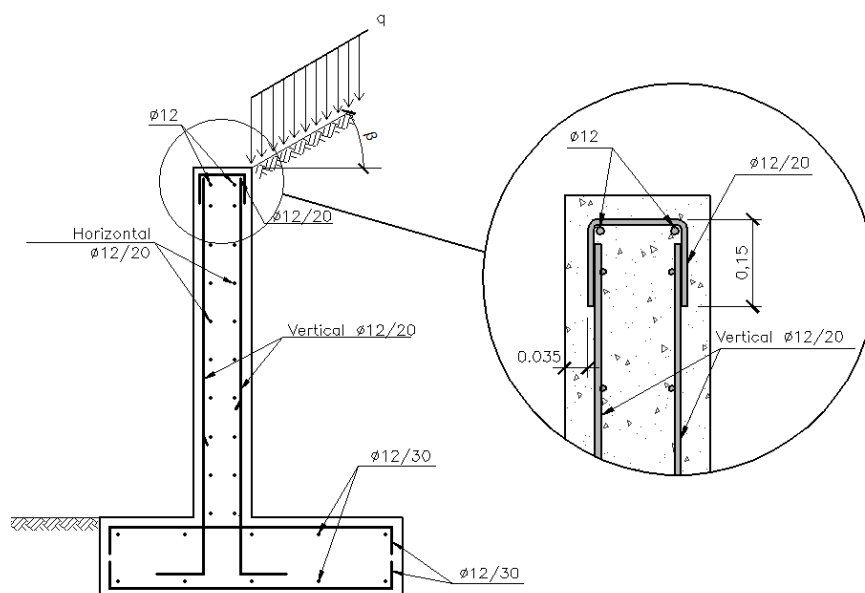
Perfiles de muro tipo de hormigón armado. Fuente: Elaboración propia.
